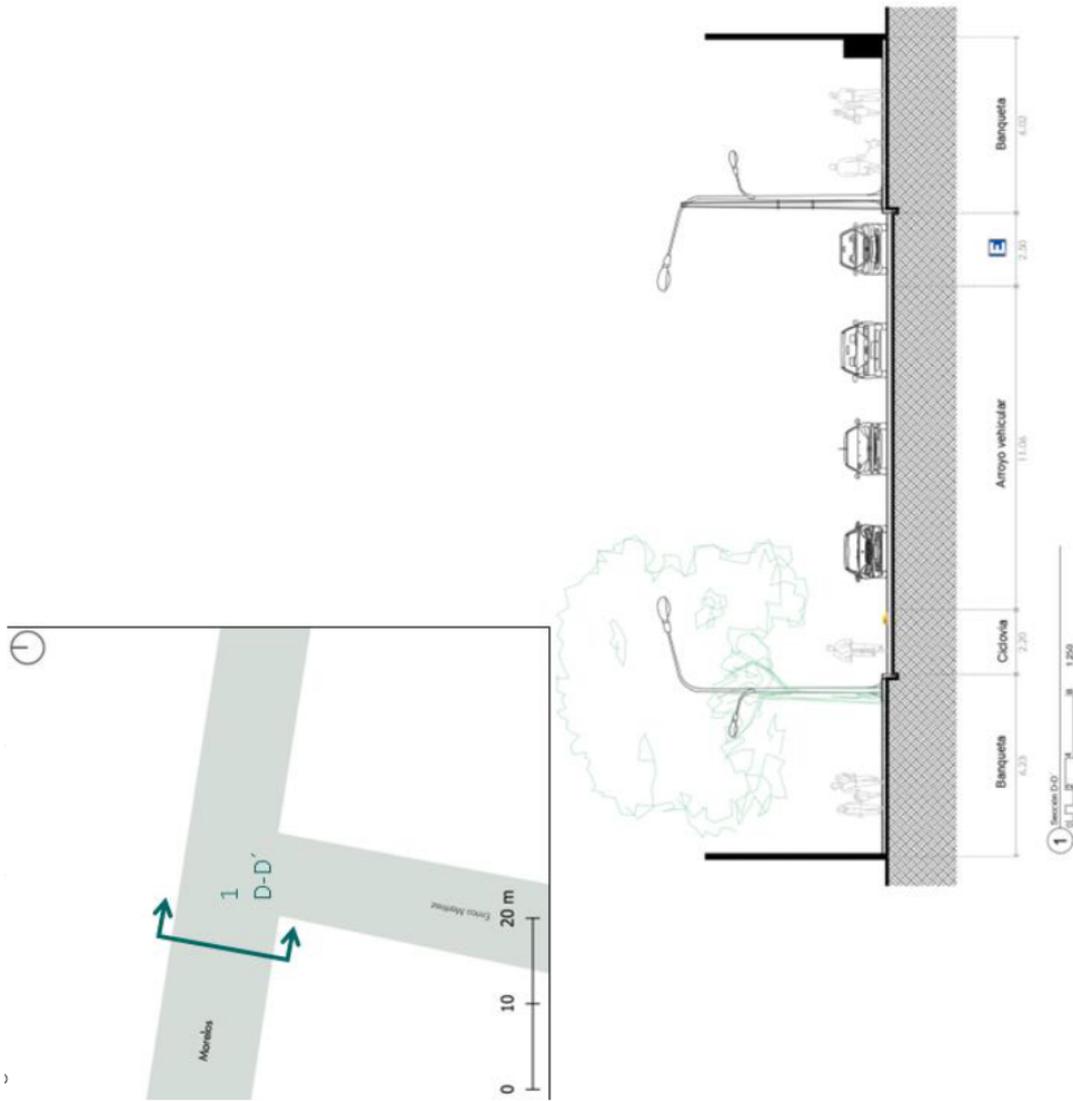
Sección transversal D-D'. Fuente TEUP
